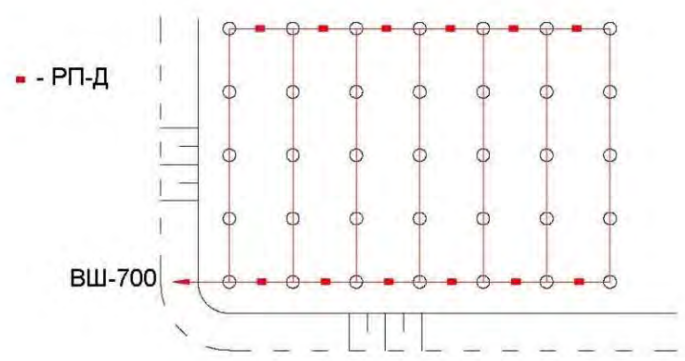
Поперечная схема монтажа с применением детонирующего шнура
